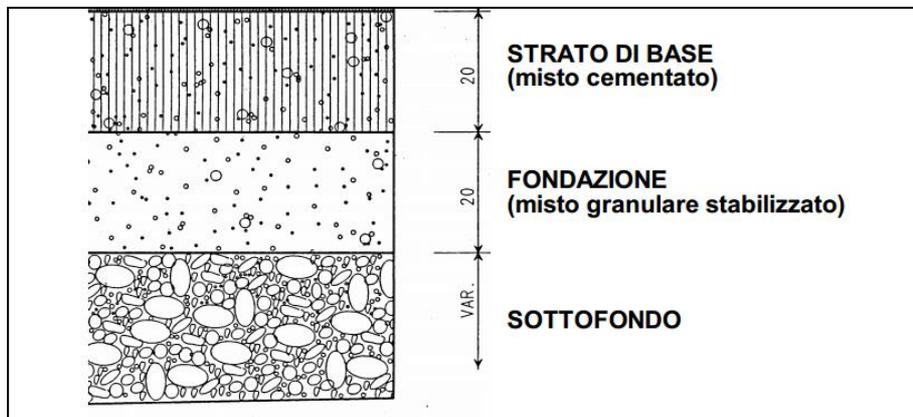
Stratigrafia pavimentazione stradale - Esempio
